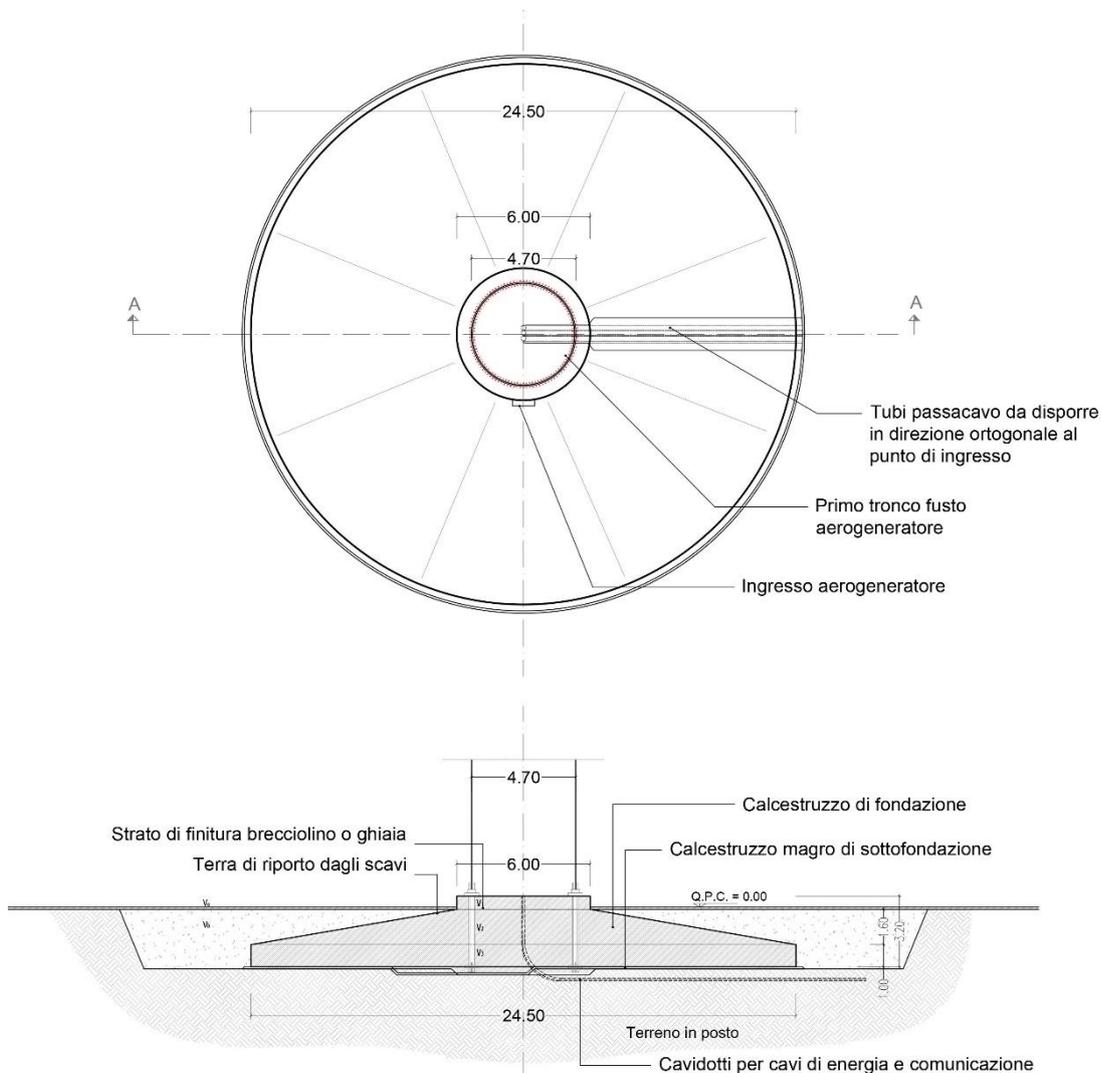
Pianta e vista della fondazione tipo dell'aerogeneratore
